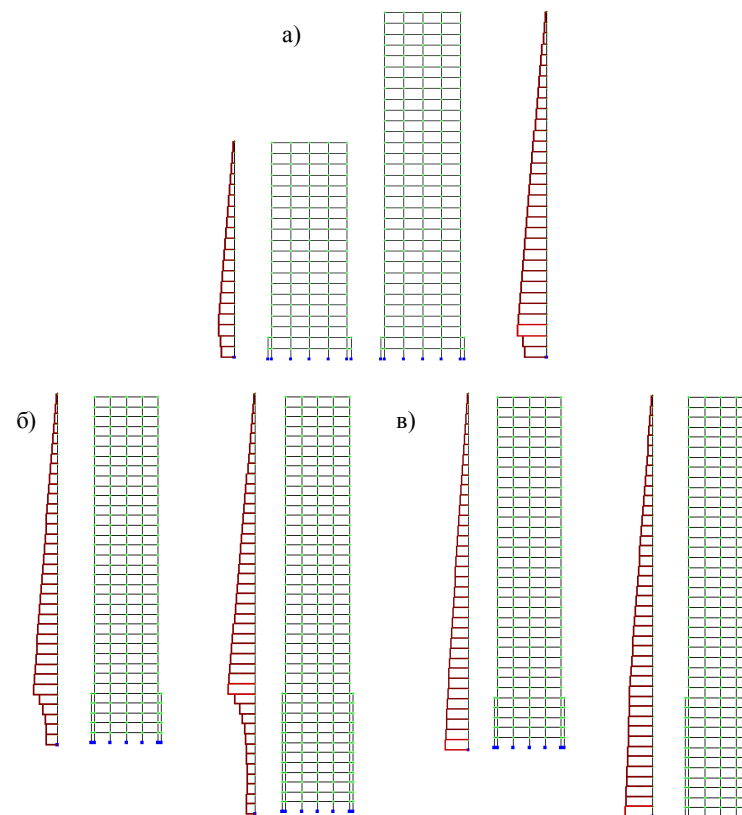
Влияние конструктивной схемы высотного здания на усилия в колоннах: а) расчетные схемы зданий высотой 60 и 96 м и эпюры усилий в крайних колоннах этих зданий; б) эпюры усилий в крайних колоннах зданий при линейном расчете; в) то же, при нелинейном расчете
